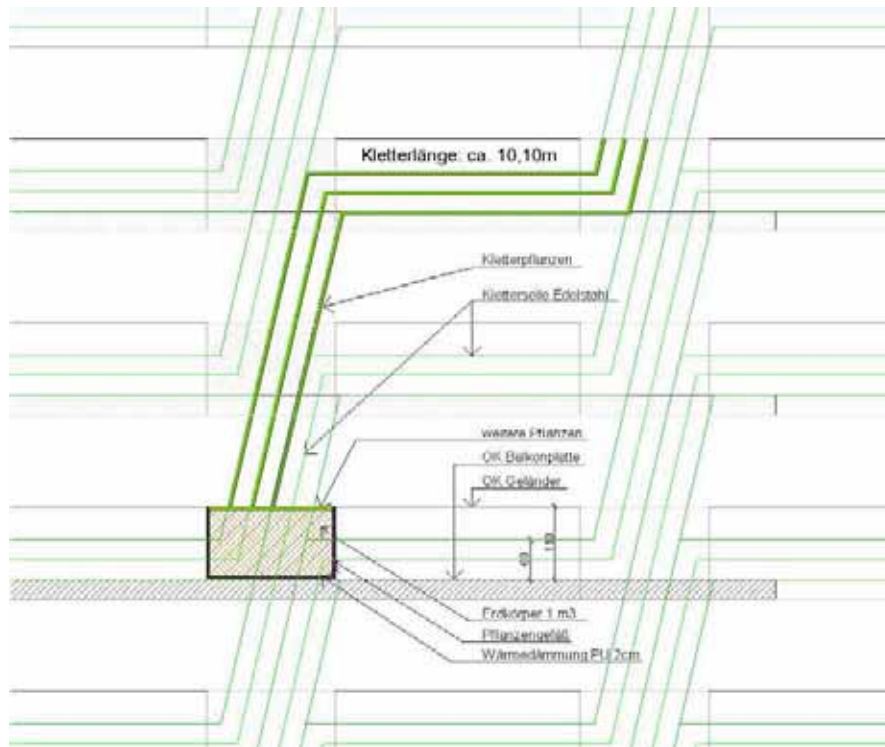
Pflanzkonstruktion Ansicht und Grundriss
